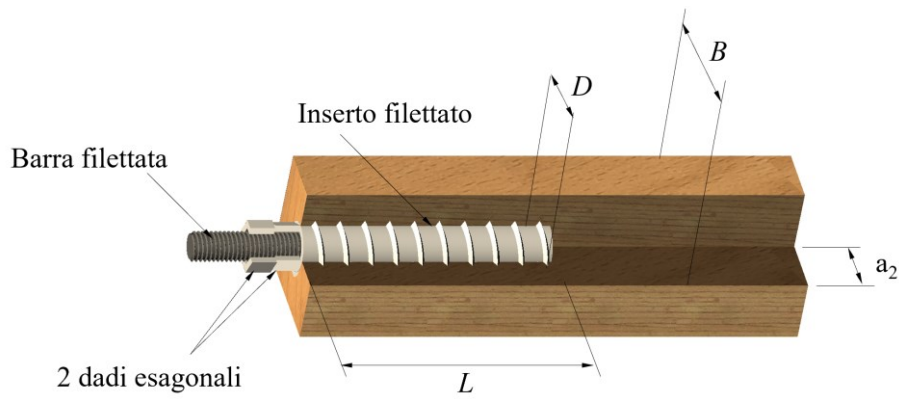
Sezione assometrica del Giunto Tipologia E
